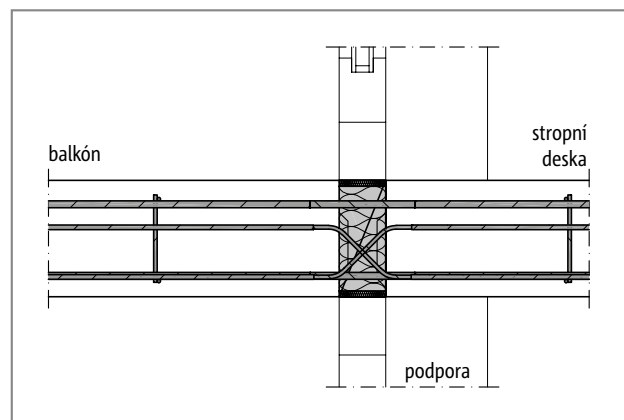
Schöck Isokorb® T typ DL a typ QL: Křížem vyztužená deska, prvek Schöck Isokorb® ale působí pouze v jednom směru
